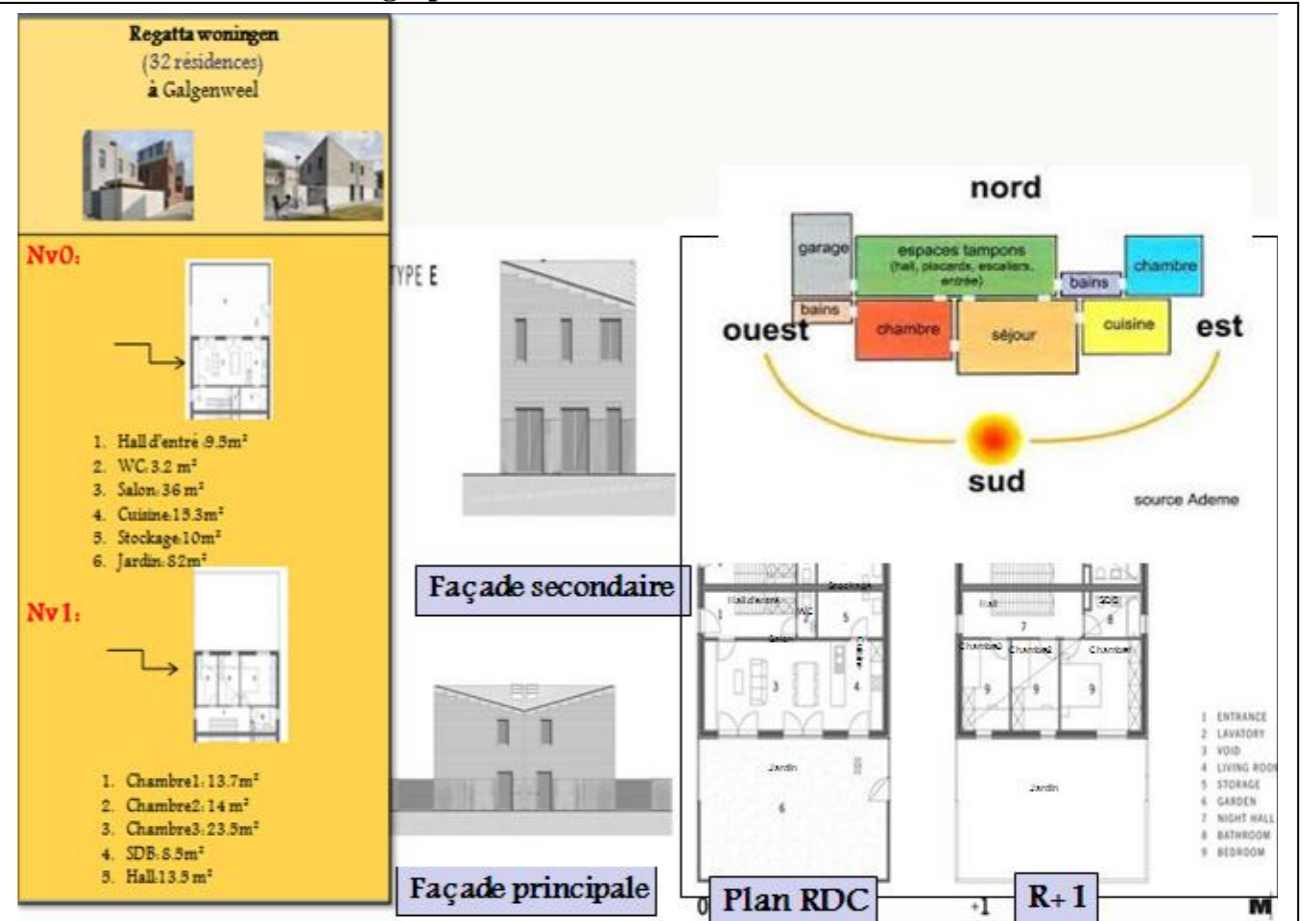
Un exemplaire des façades ; plans ; surfaces d'une unité type E
